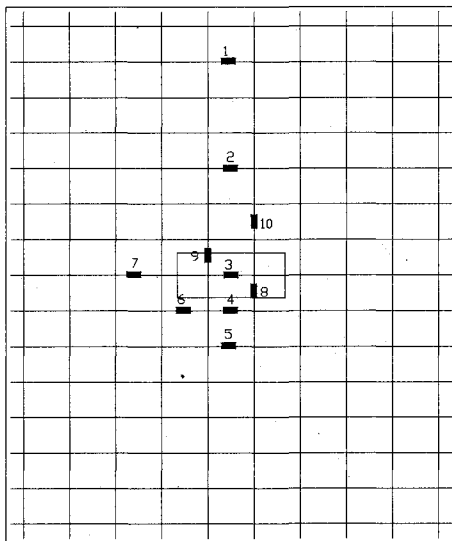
Localisations des jauges sur les barres d'armature des assemblages supérieur et inférieur de toutes les dalles d'essai
